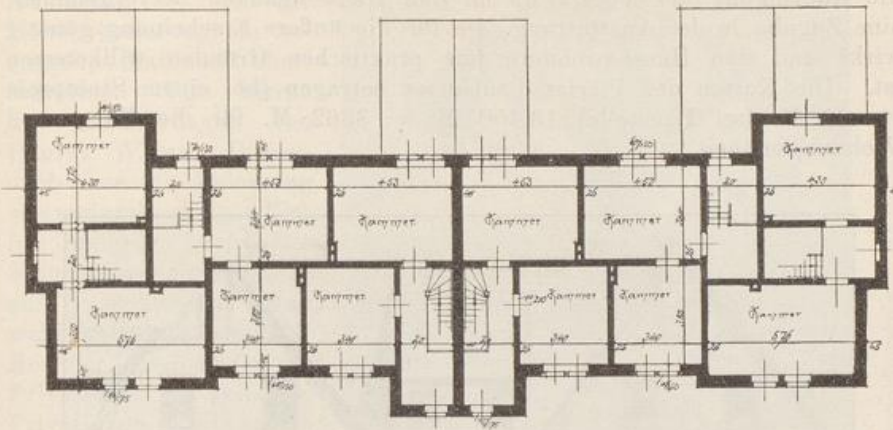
Grundriß zu Abb. 98. Dachgeschoß.
